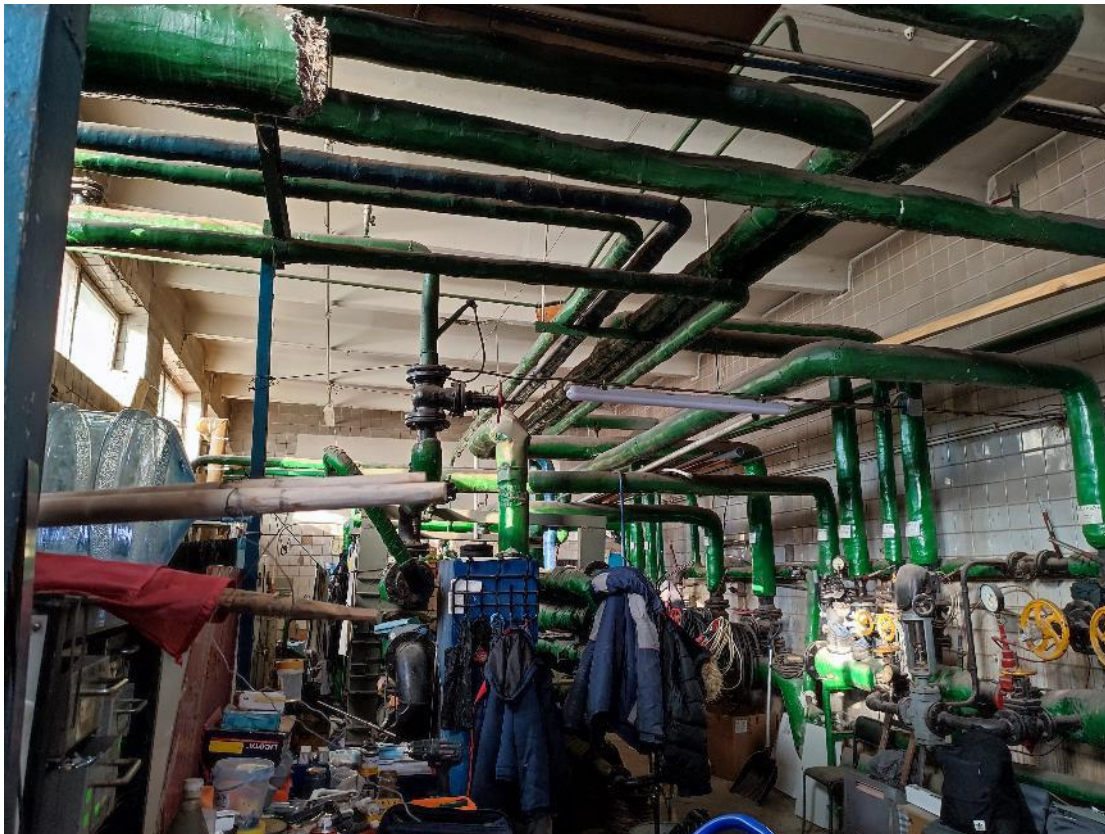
Общий вид конструкций здания в осях 2-3/А-Б
